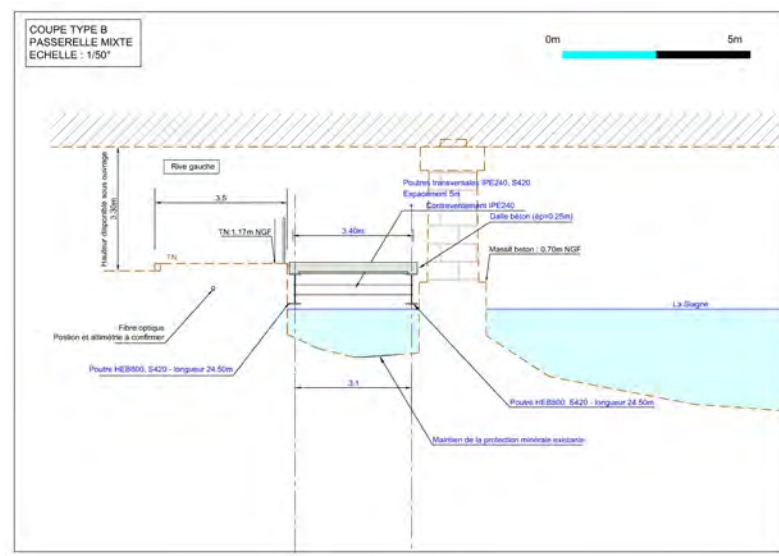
RAPPEL DE LA COUPE TYPE ZONE SOUS PONT SNCF
